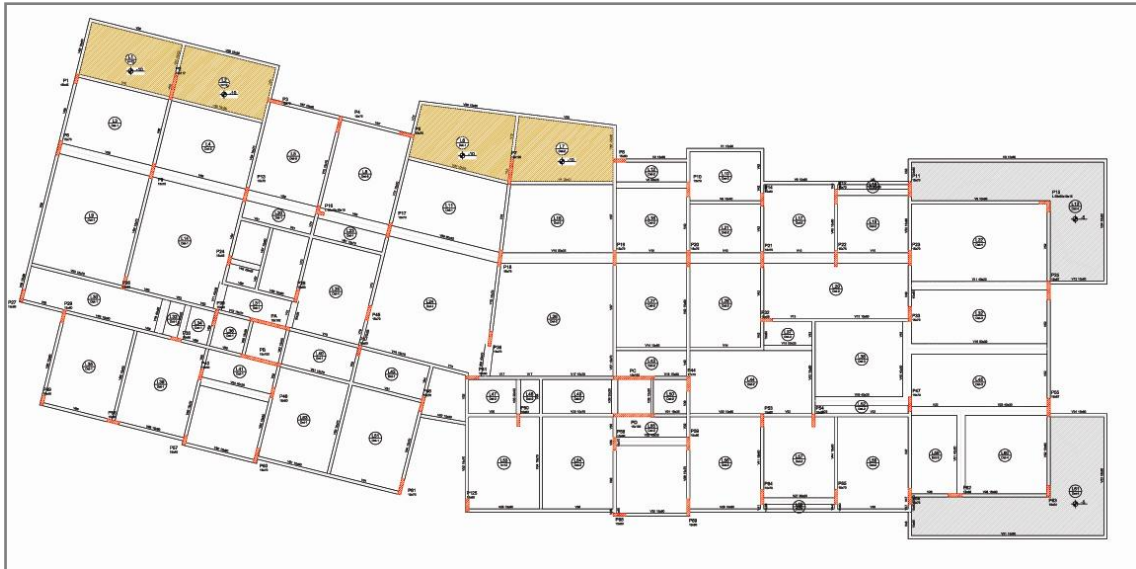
Planta de forma do projeto estrutural do pavimento tipo do bloco 03.
